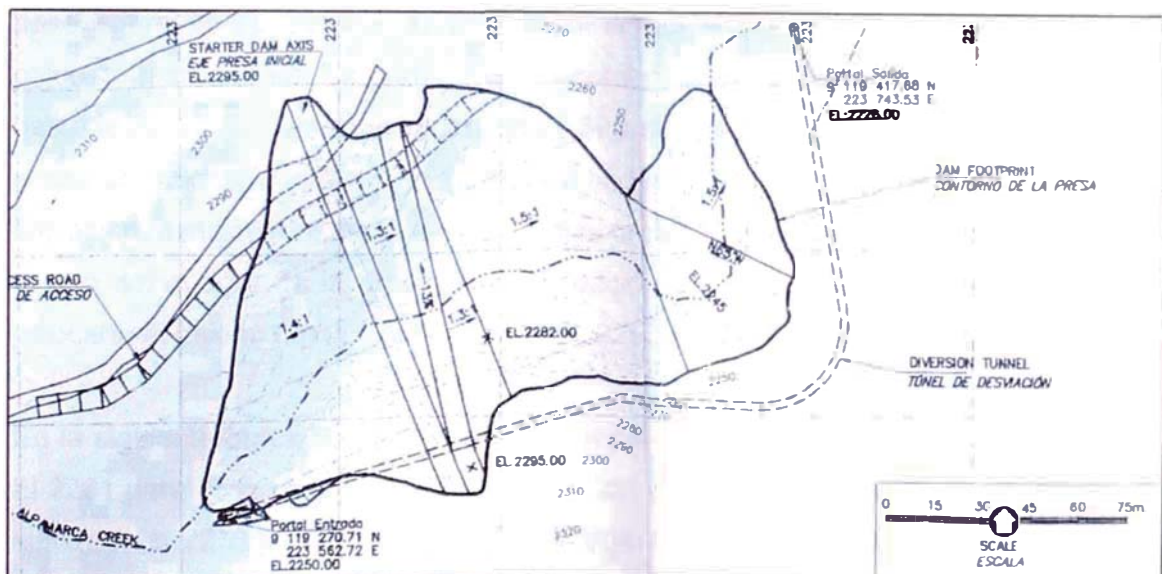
Se puede observar los accesos definidos para la alternativa de construcción N° 1.
